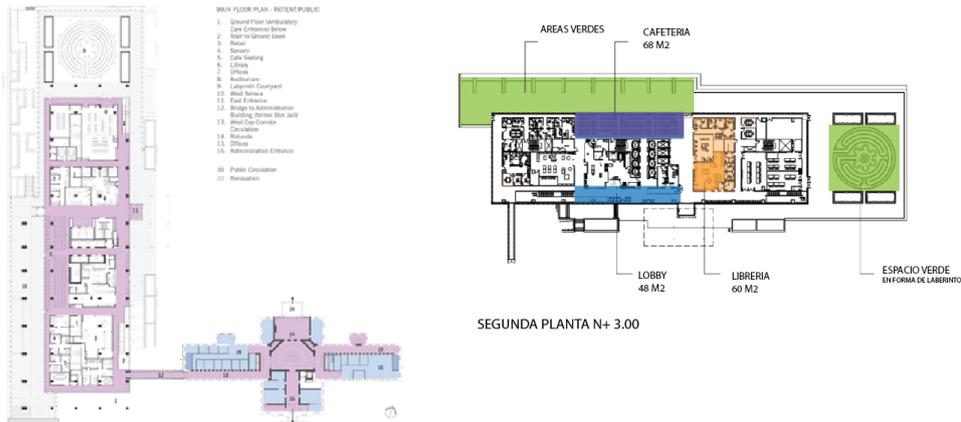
Planta II y distribución. Realizado por: Diana Flores
